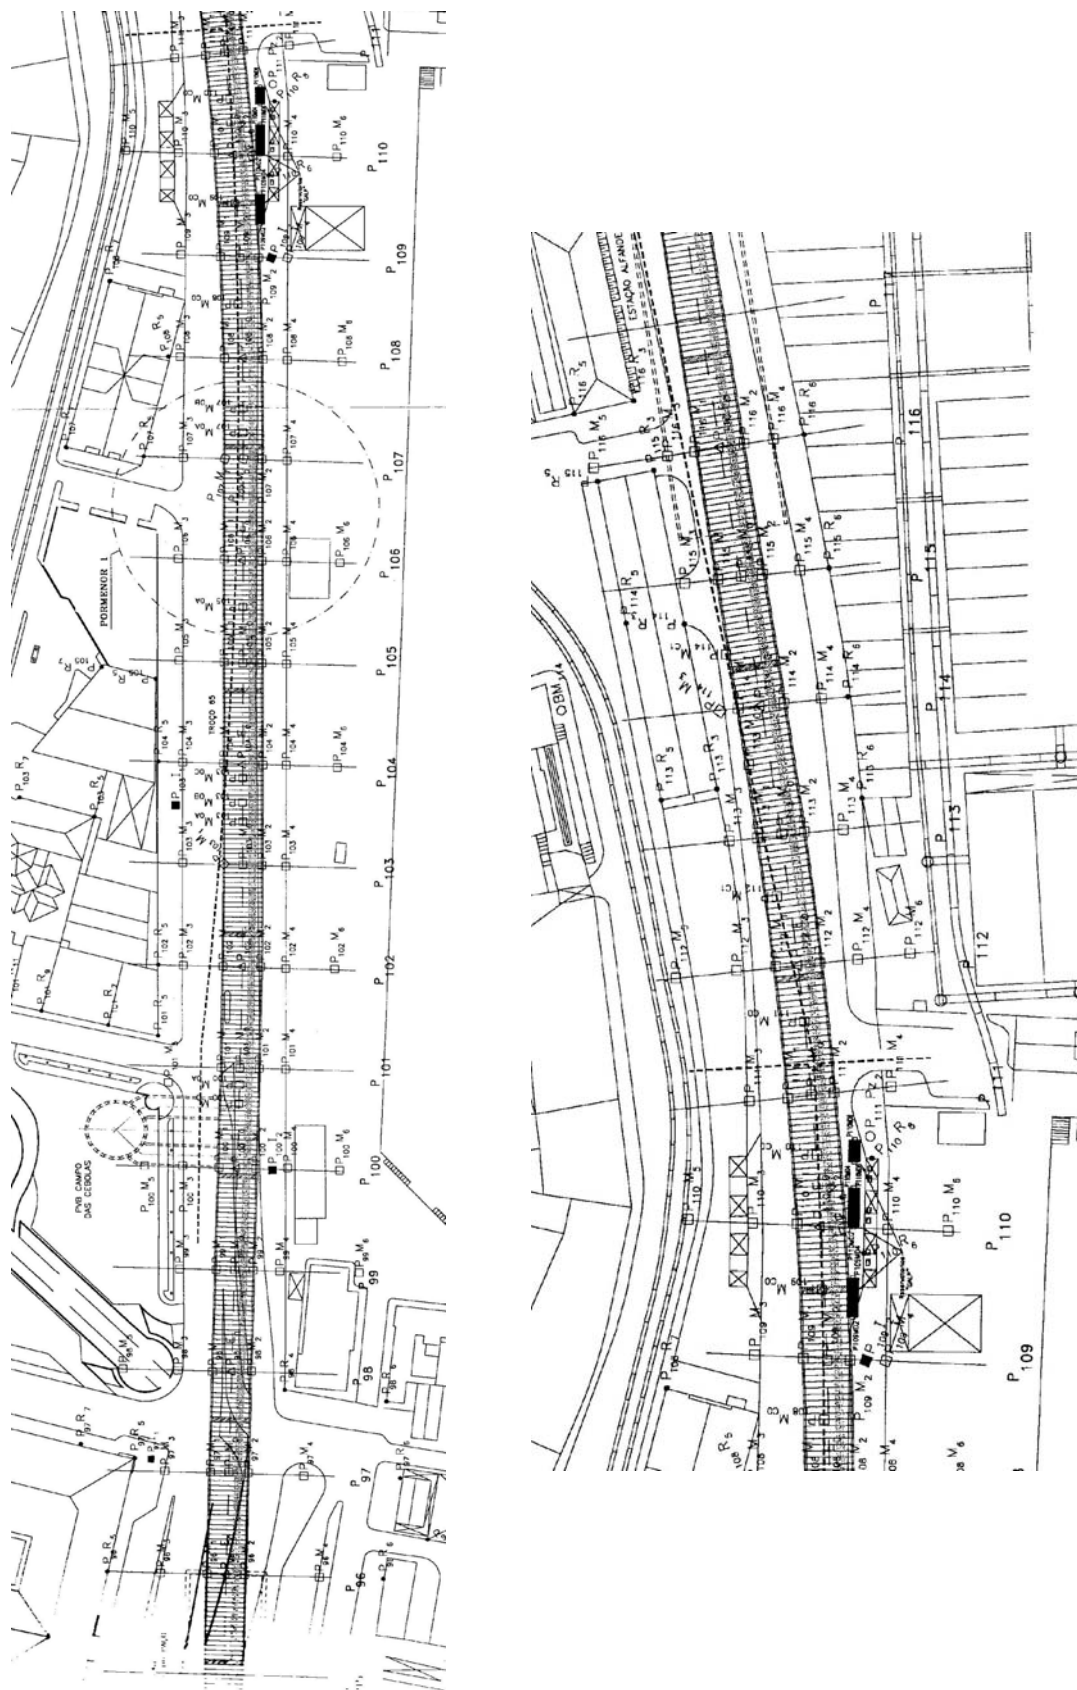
Planta de localização da instrumentação do troço 65 – Terreiro do Paço – Santa Apolónia. Secções P96 a P116
